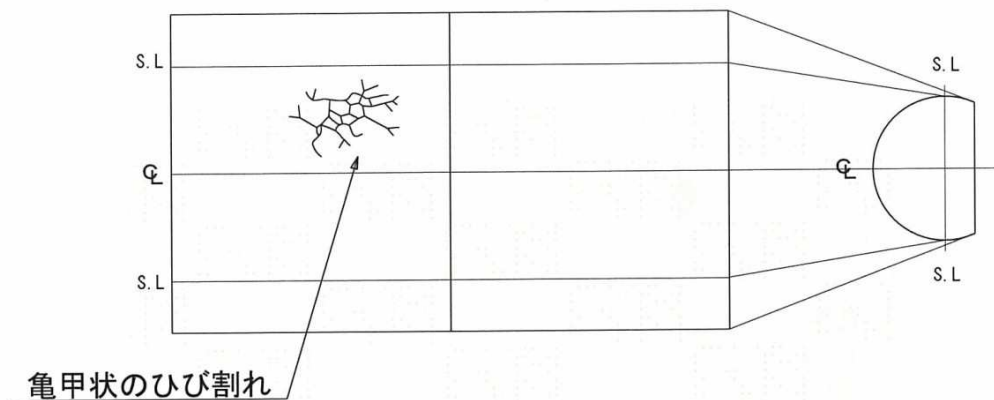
覆工コンクリートの亀甲状のひび割れによる細片化の例
